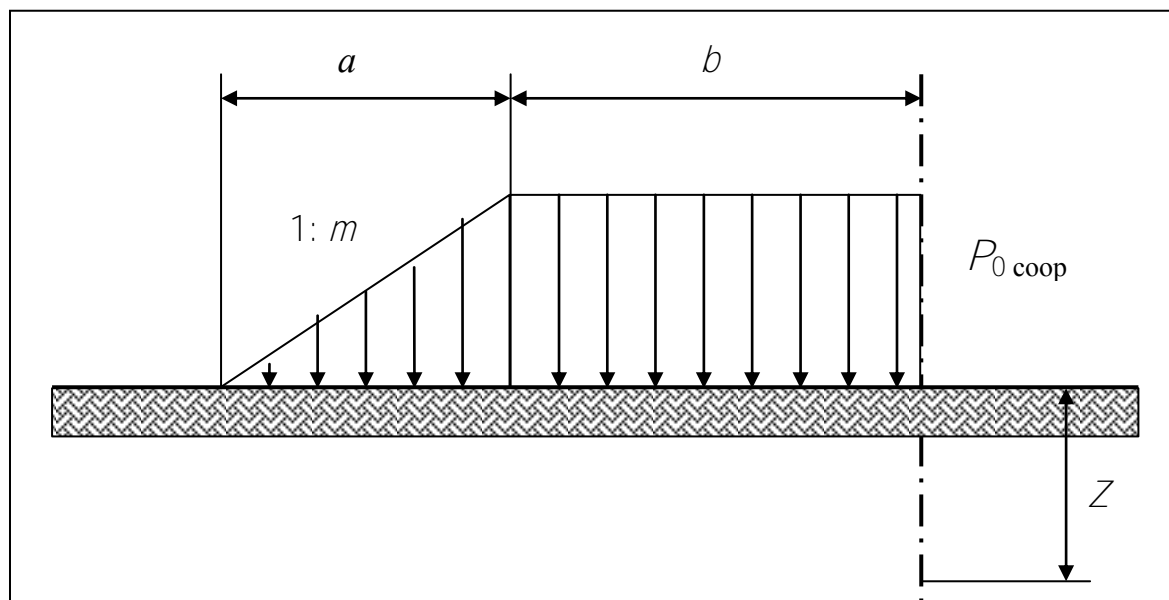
Расчетная схема трапециевидной нагрузки
